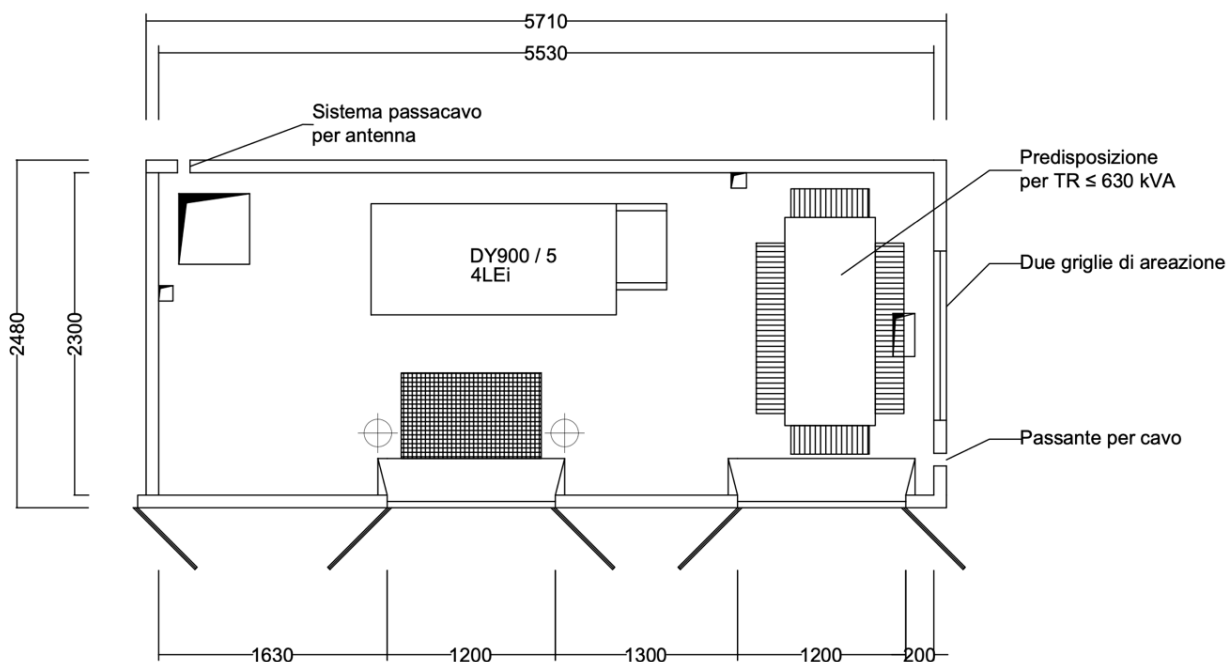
Planimetria della cabina di sezionamento DG20261 ed.09
